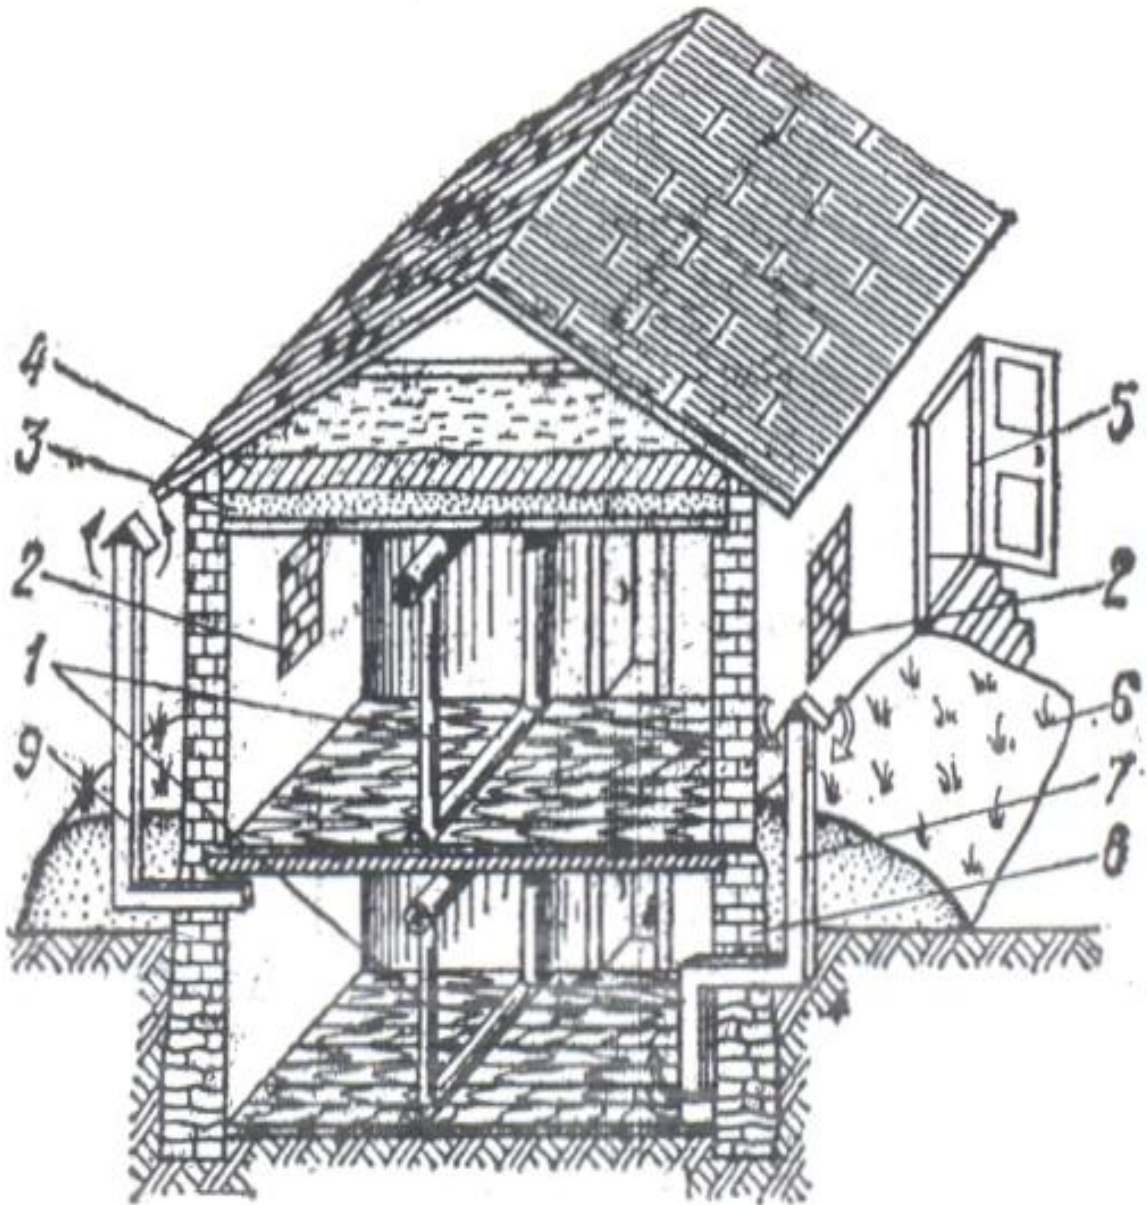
Приспособление подвала каменного дома под ПРУ:
